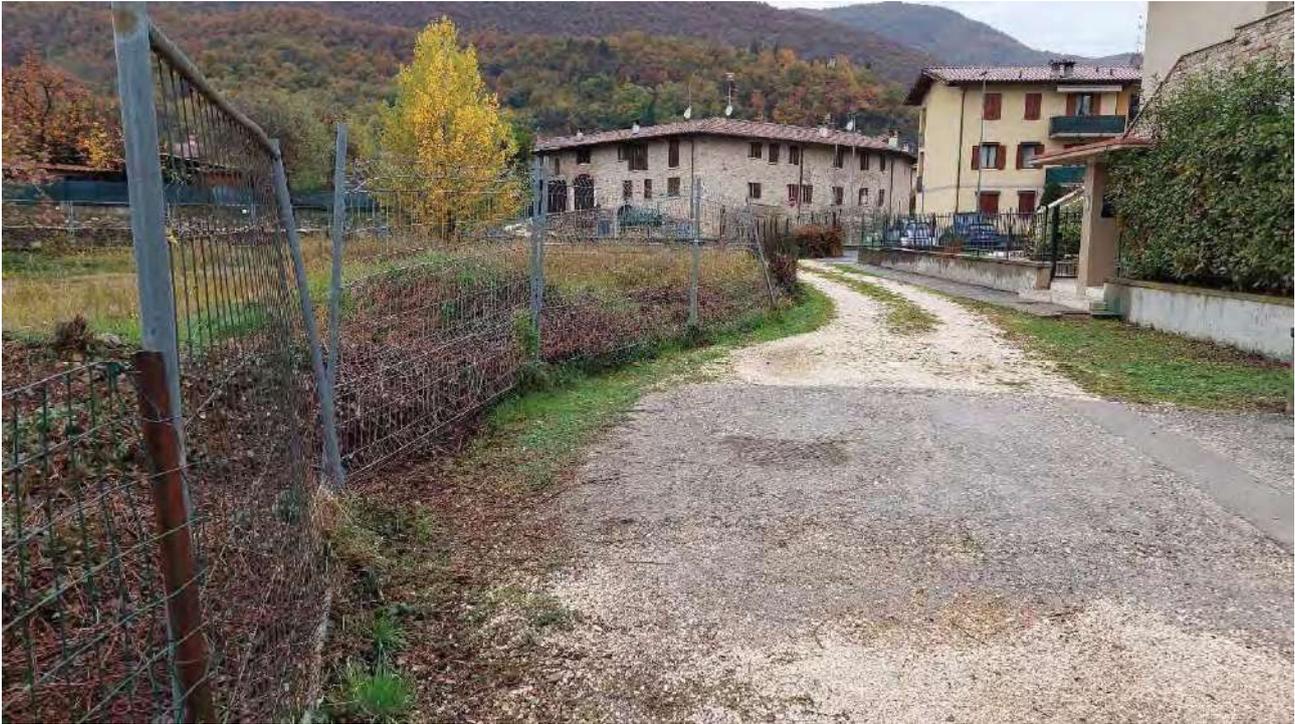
Vista interna dell'area, fronte est verso la strada privata da realizzarsi
